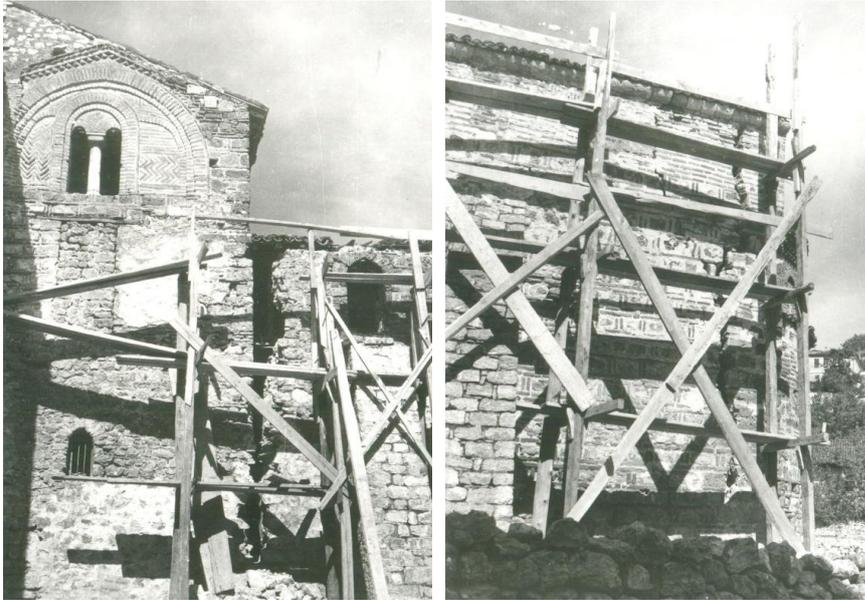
Liberación de la fachada sur de las conexiones con los muros transversales mediante el aumento y limpieza de fisuras existentes.
